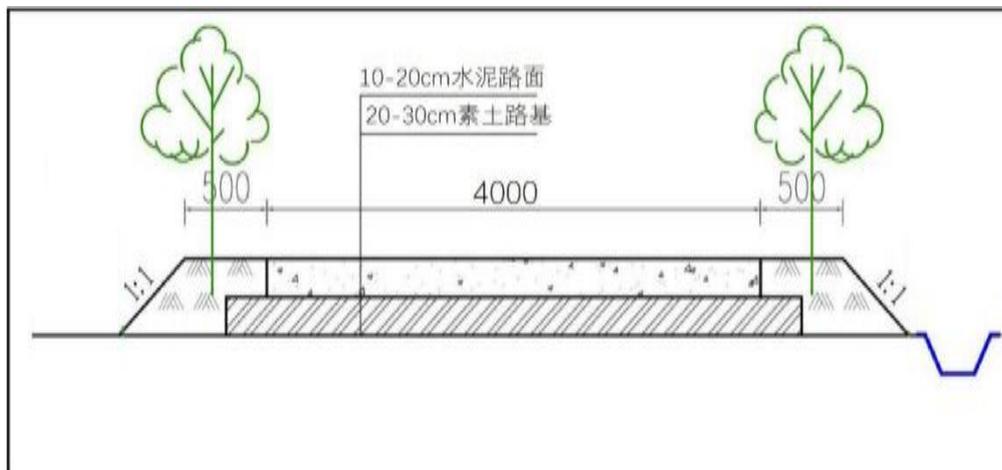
道路复垦断面示意图（路面单位：mm）
